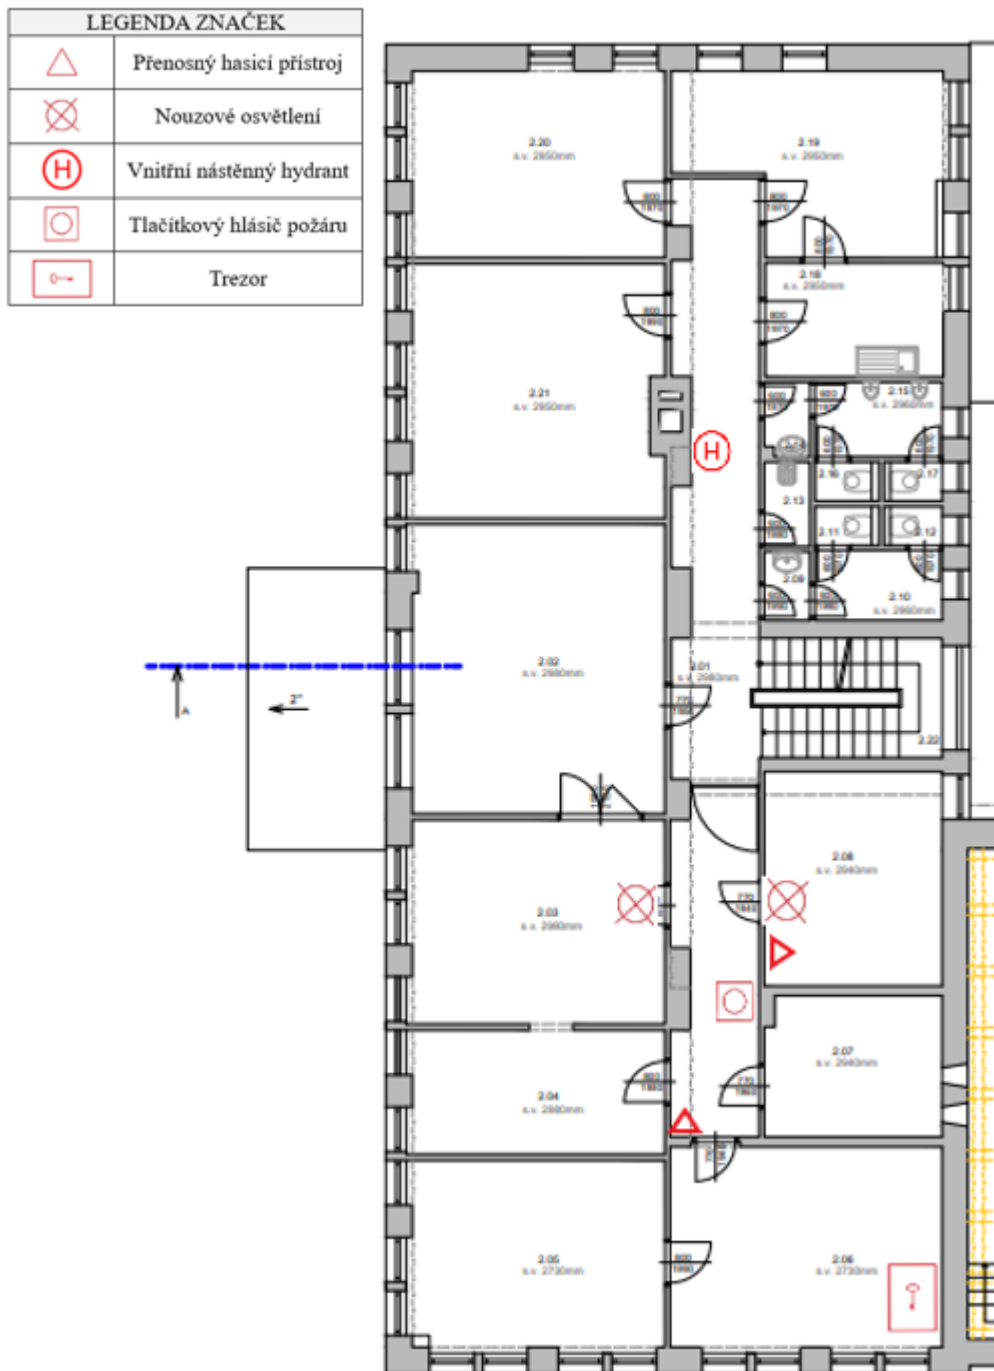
Půdorys podzemního patra se stávajícím zabezpečením
